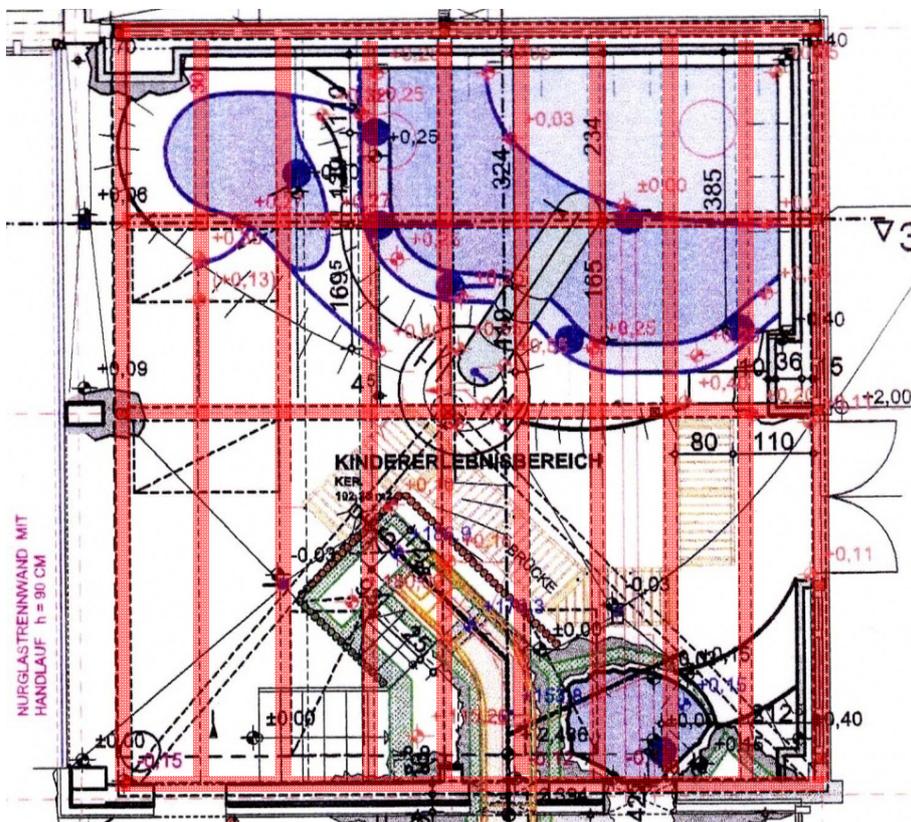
Grundriss Kindererlebnisbereich mit Deckenbalken
